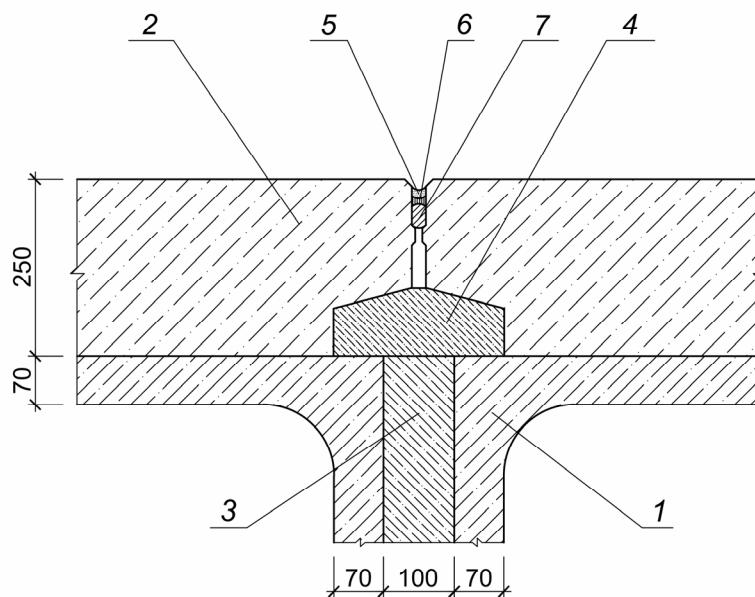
Схема проектного решения сопряжения внутренних и наружных стен (система дополнительного утепления наружных стен с вентилируемым фасадом не показана): 1 — железобетонная конструкция объемного блока; 2 — навесная панель из керамзитобетона; 3 — железобетонная шпонка; 4 — заделка межпанельного шва керамзитобетоном; 5 — защитное покрытие; 6 — герметизирующая мастика; 7 — уплотняющая прокладка
